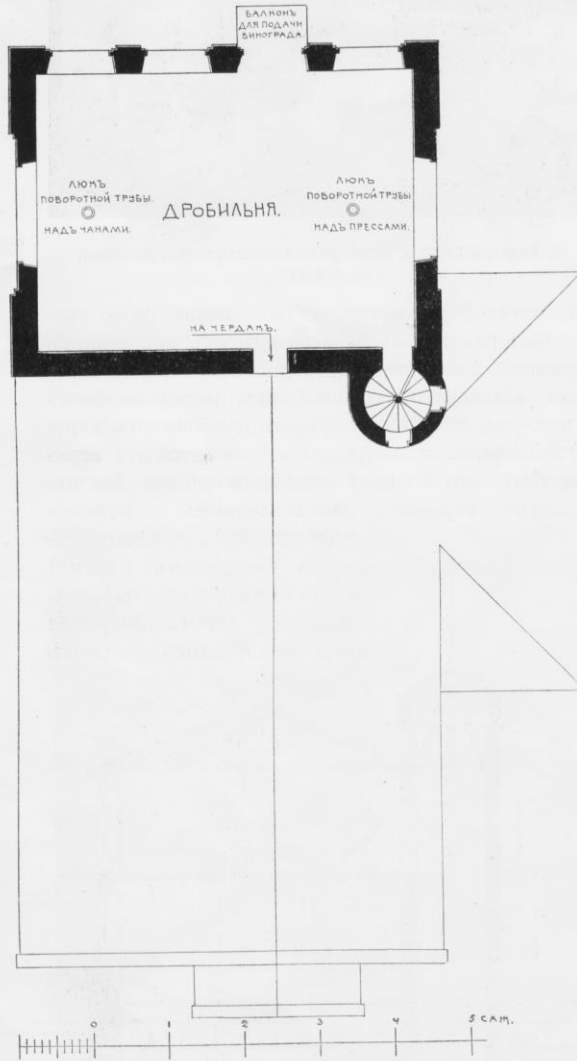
Подвалъ Станціи. Планъ верхняго этажа — дробильни.
